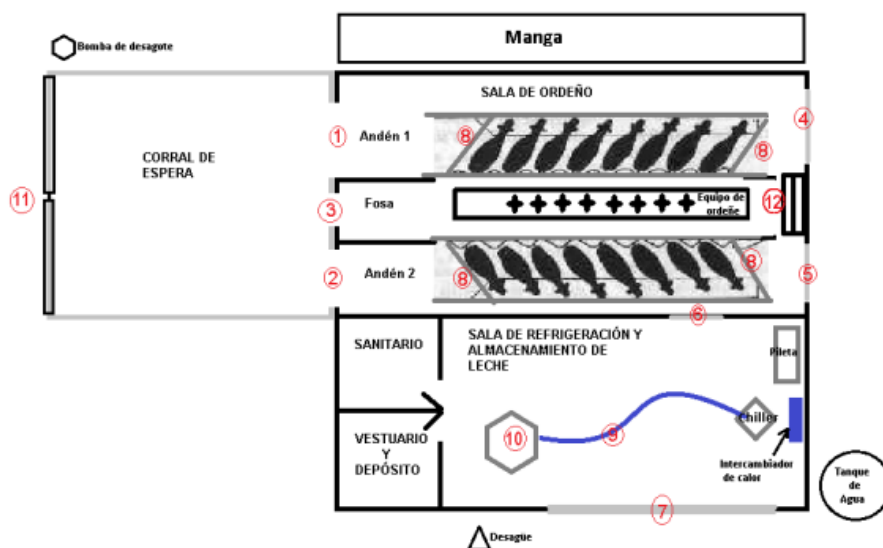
Ejemplo de lay-out o distribución en planta de instalación lechera
